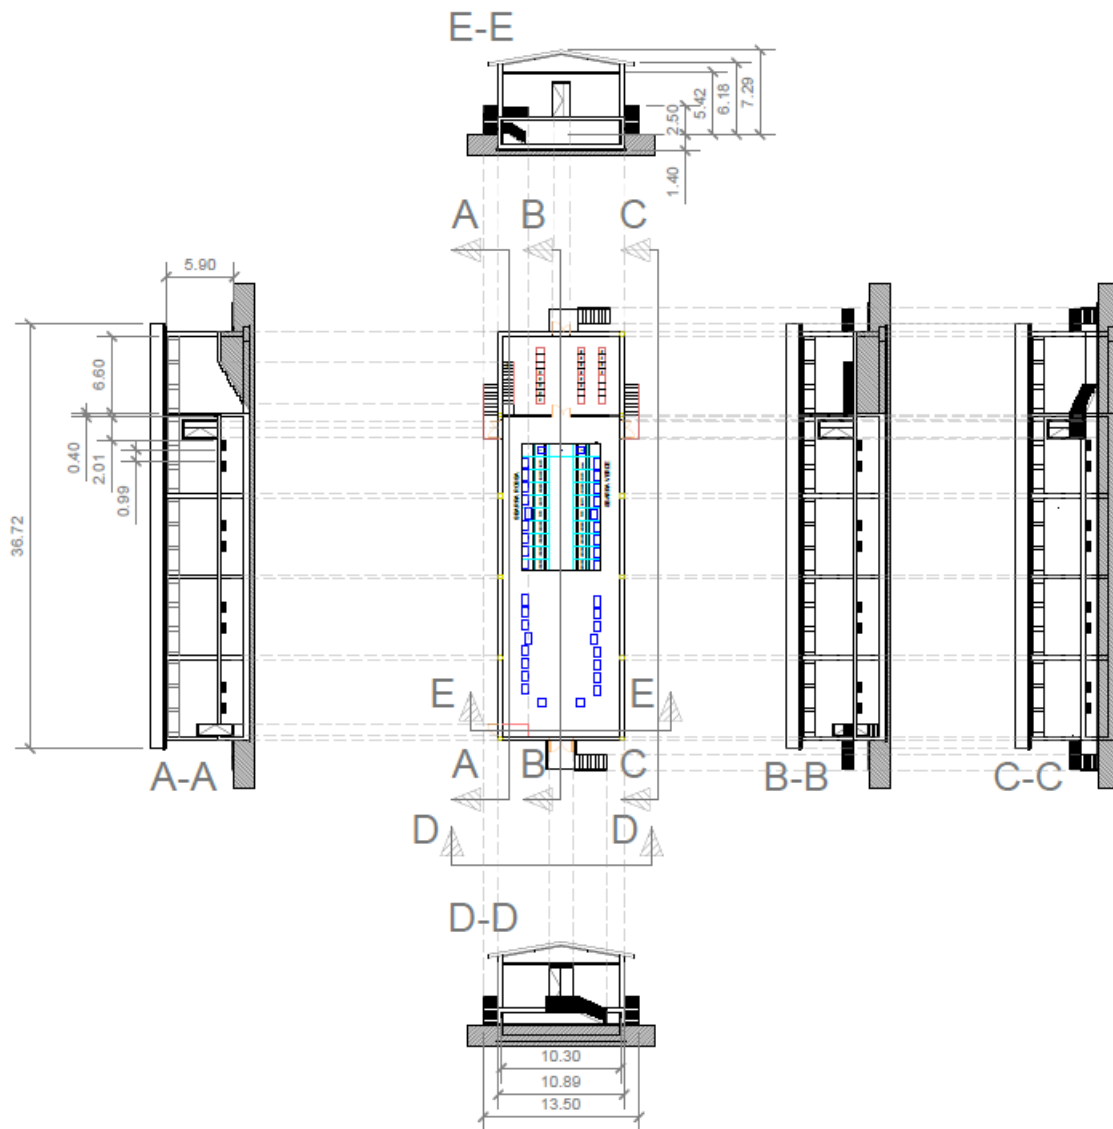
Layout e sezioni dell'edificio bipiano MT da realizzare in CP Castel Maggiore – Misure in metri
